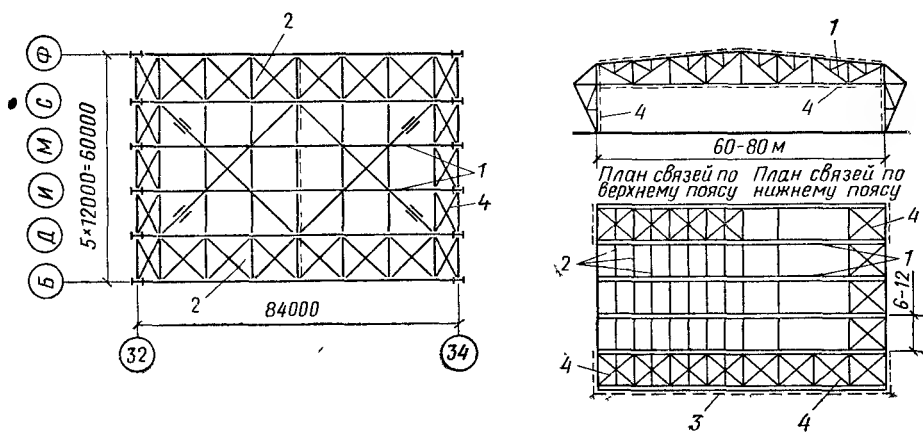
Поперечная планировка конструкции покрытия ангара
